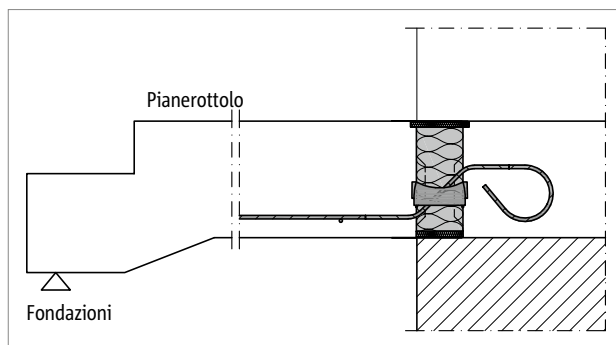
Schöck Isokorb® T tipo QL: raccordo della rampa a muratura termoisolante monostrato
